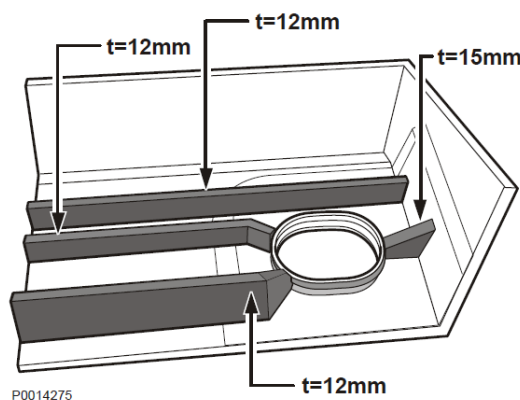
Distribución de refuerzos longitudinales Fuente: *Installation, Volvo Penta IPS
